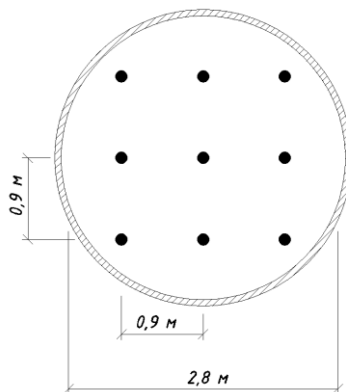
Схема расположения пропарочных скважин в бетонной смеси при цилиндрической конструкции формы-автоклава
